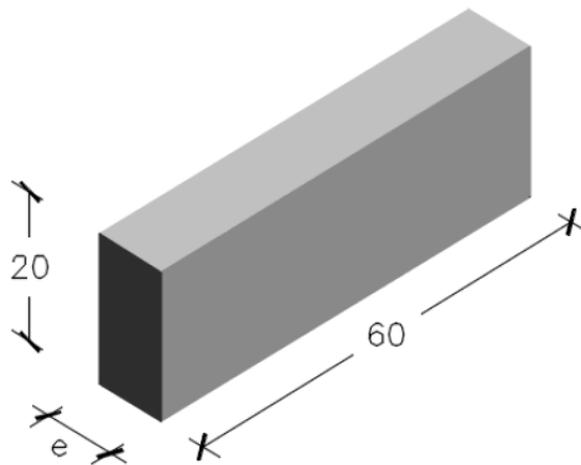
Block normal de Concreto Celular / Imagen de las fichas técnicas AICRET SMKT
